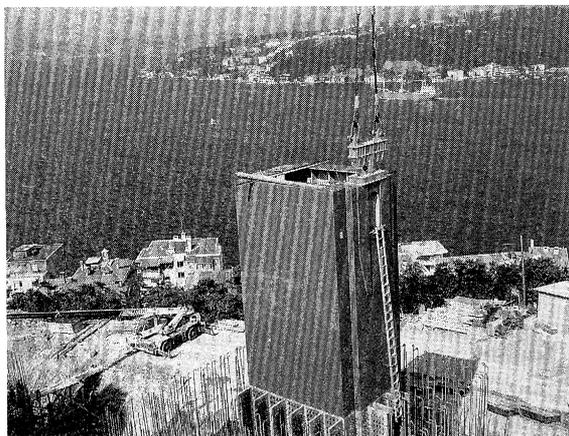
第2ボスポラス橋塔基部施工状況
